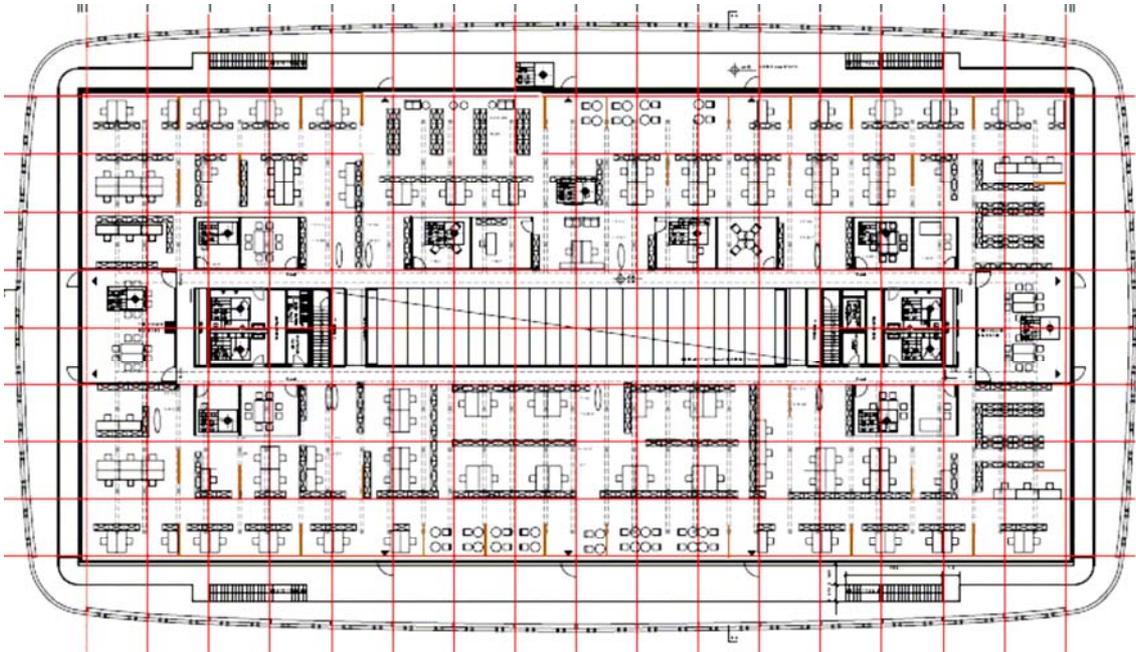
Grundriss Regelgeschoss Obergeschoss
